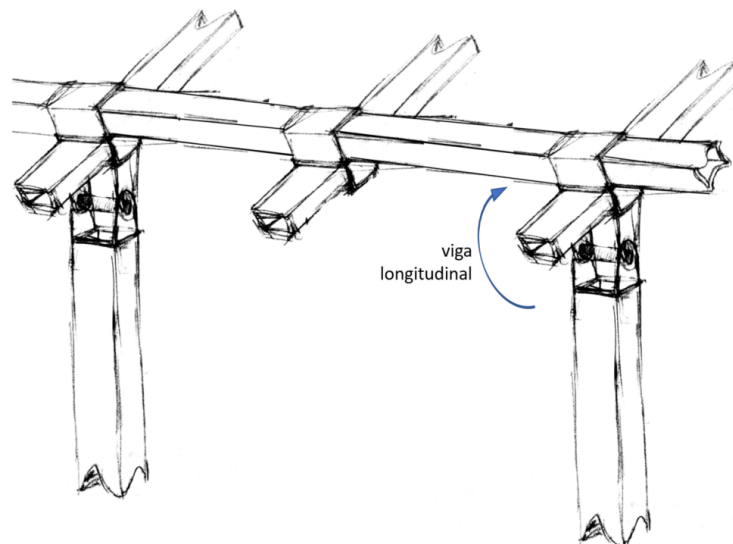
Segunda iteração com um sistema de dobradiça no encaixe pilar-viga: mudança de posição da viga longitudinal.
